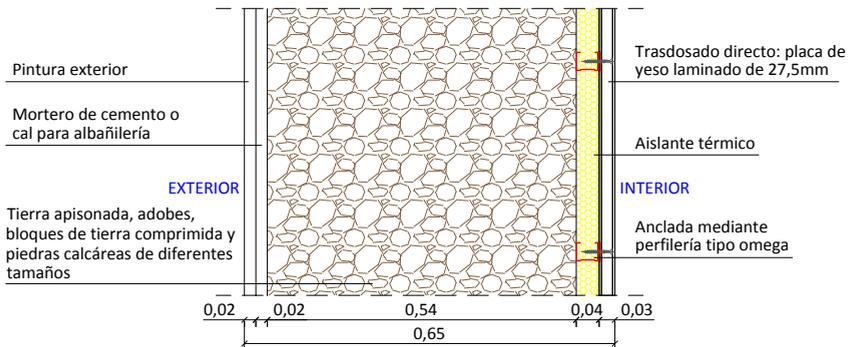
Detalle constructivo tipo del muro de la vivienda en su estado reformado con la adición de aislamiento térmico en el interior.
